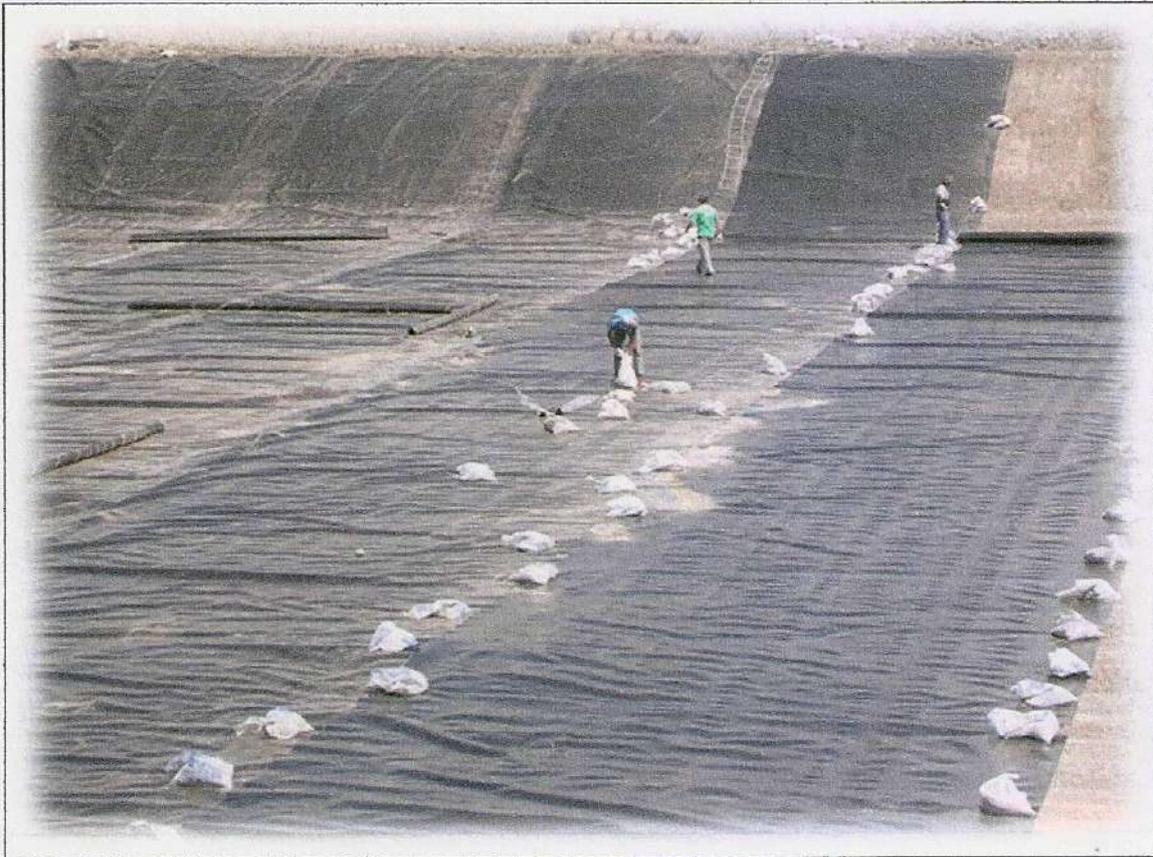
Colocación de la membrana impermeabilizante en una de las piletas.
